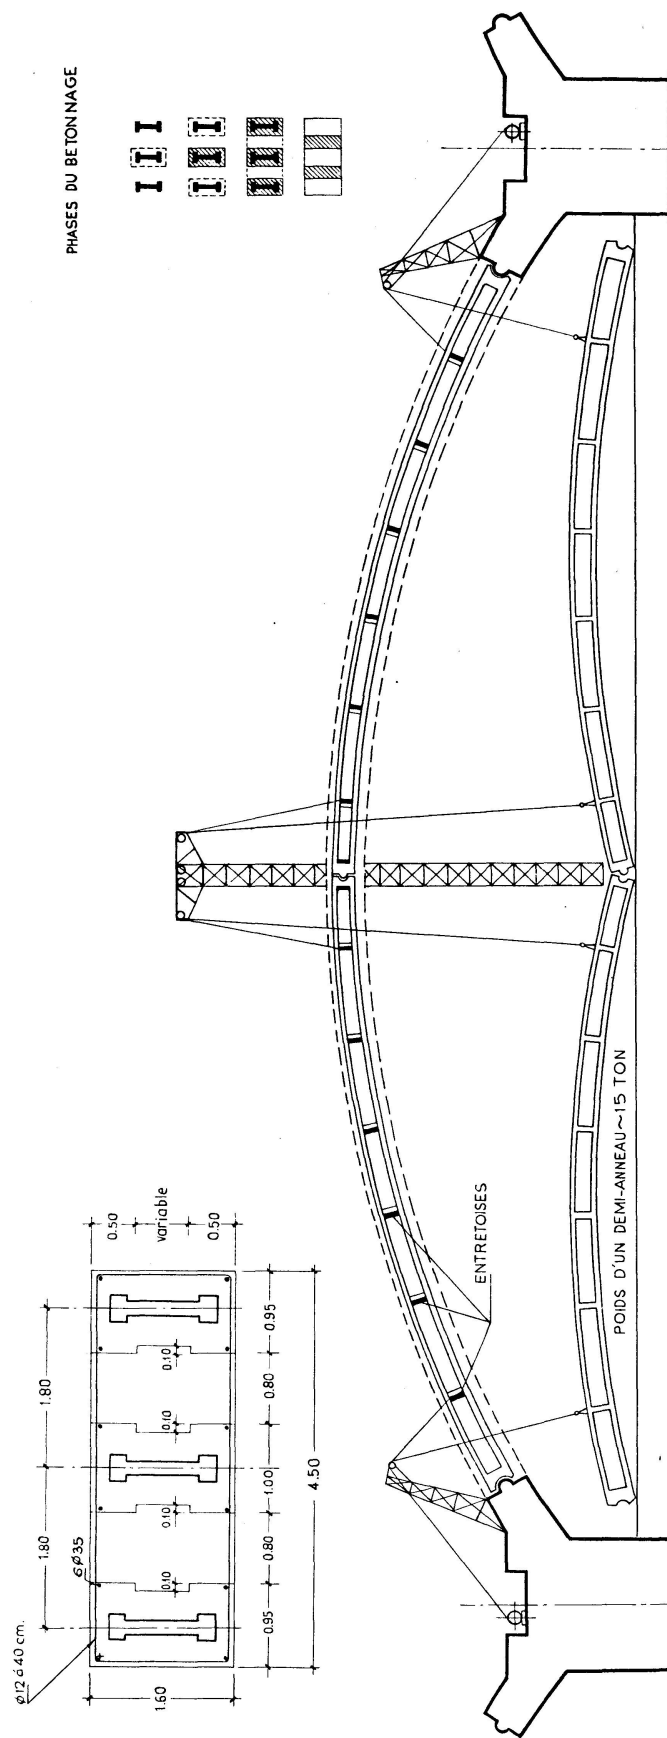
Pont de Mérida. Section d'une voûte et schéma du montage.
